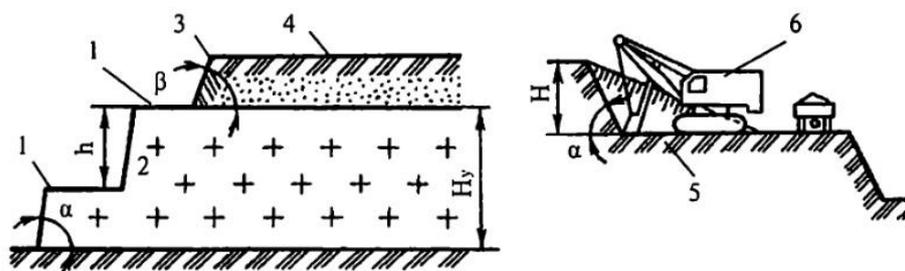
Элементы уступа: 1 – верхняя и нижняя площадки; 2 – откос уступа; 3 – бровка вскрыши; 4 – вскрыша; 5 – развал взорванной породы; 6 – экскаватор с прямой лопатой; α – угол откоса уступа; β – угол откоса вскрыши; H – высота уступа
